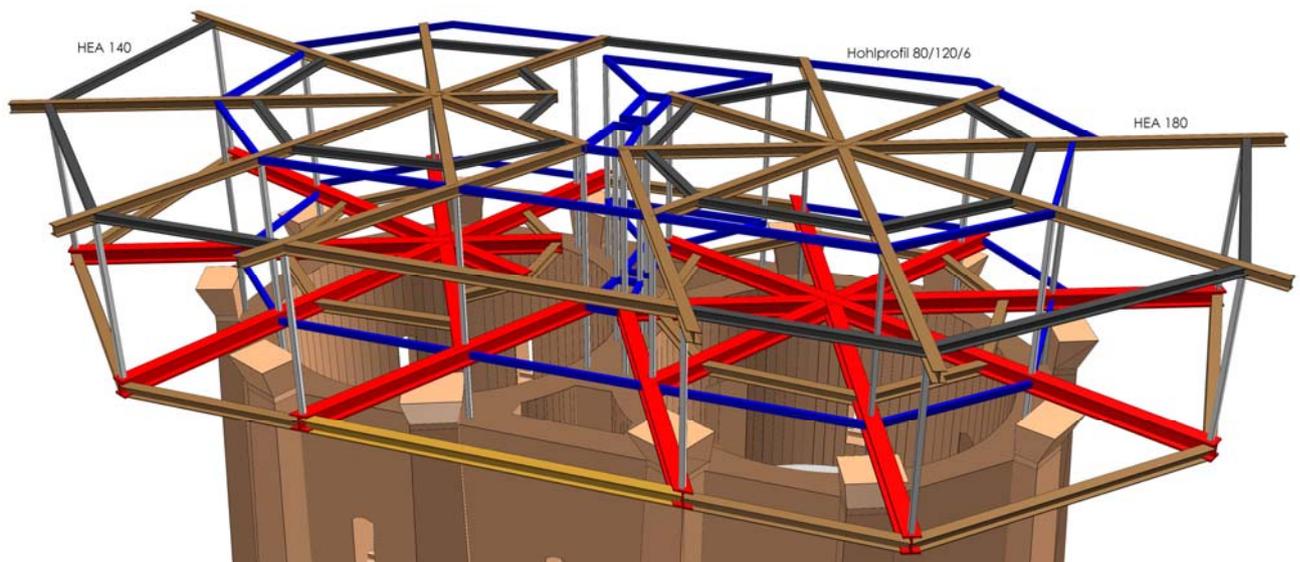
Bauteile für Trägerrost der Deckenkonstruktion:
